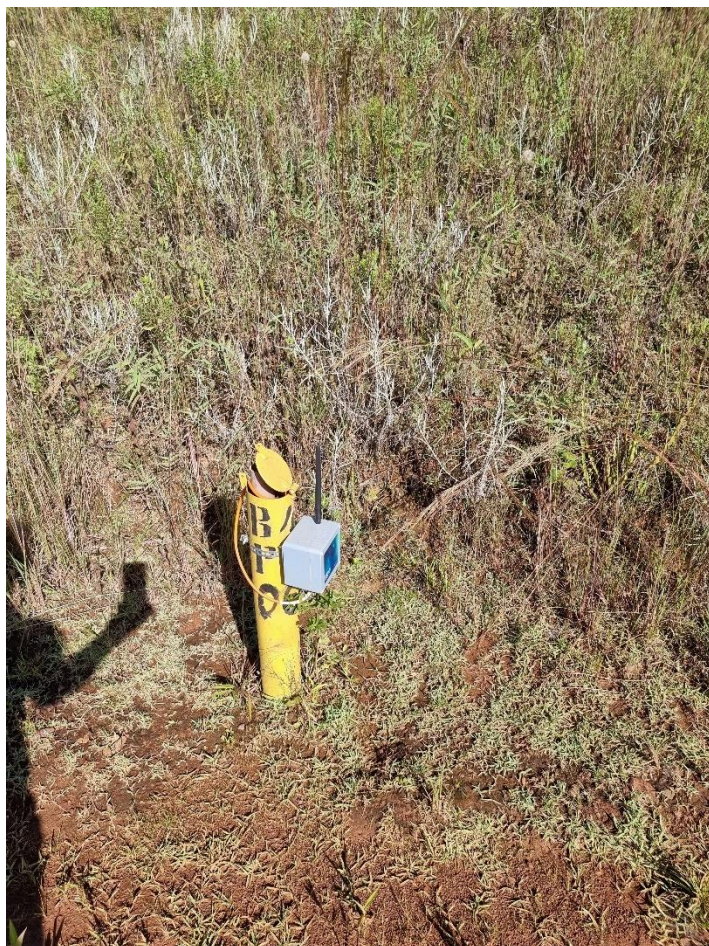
Detalhe do instrumento B4PZ06, automatizado.
